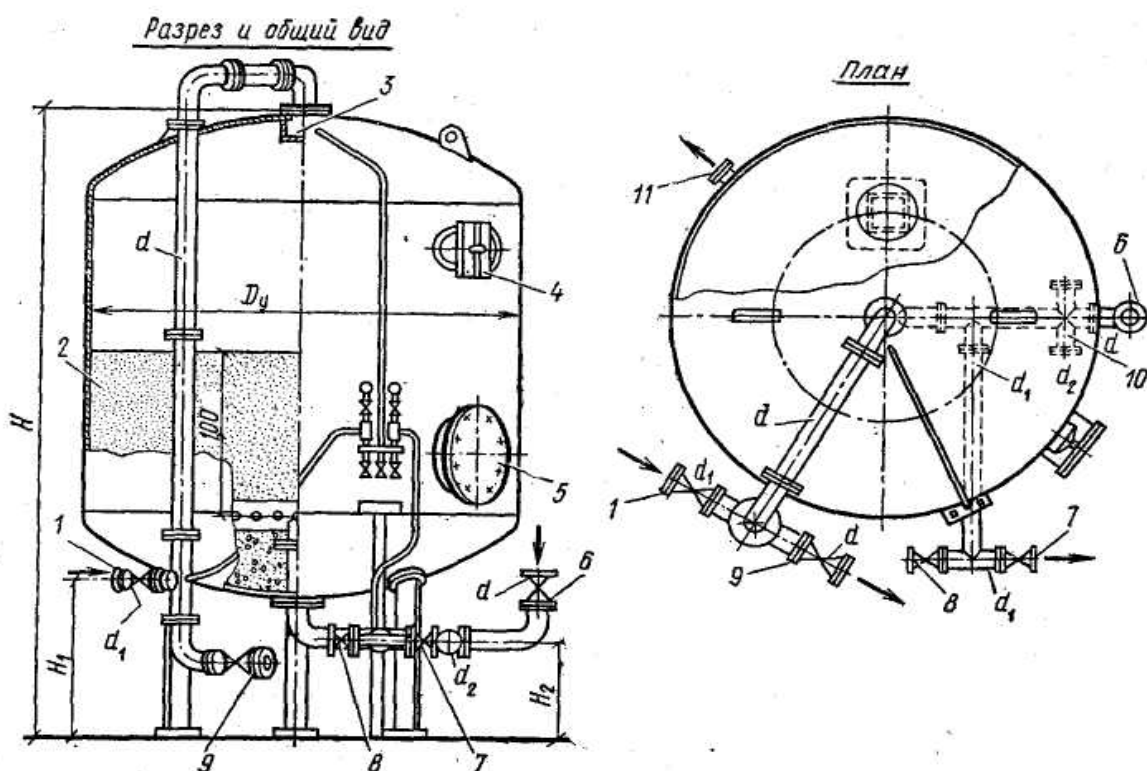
Напорный вертикальный фильтр с зернистой загрузкой:
